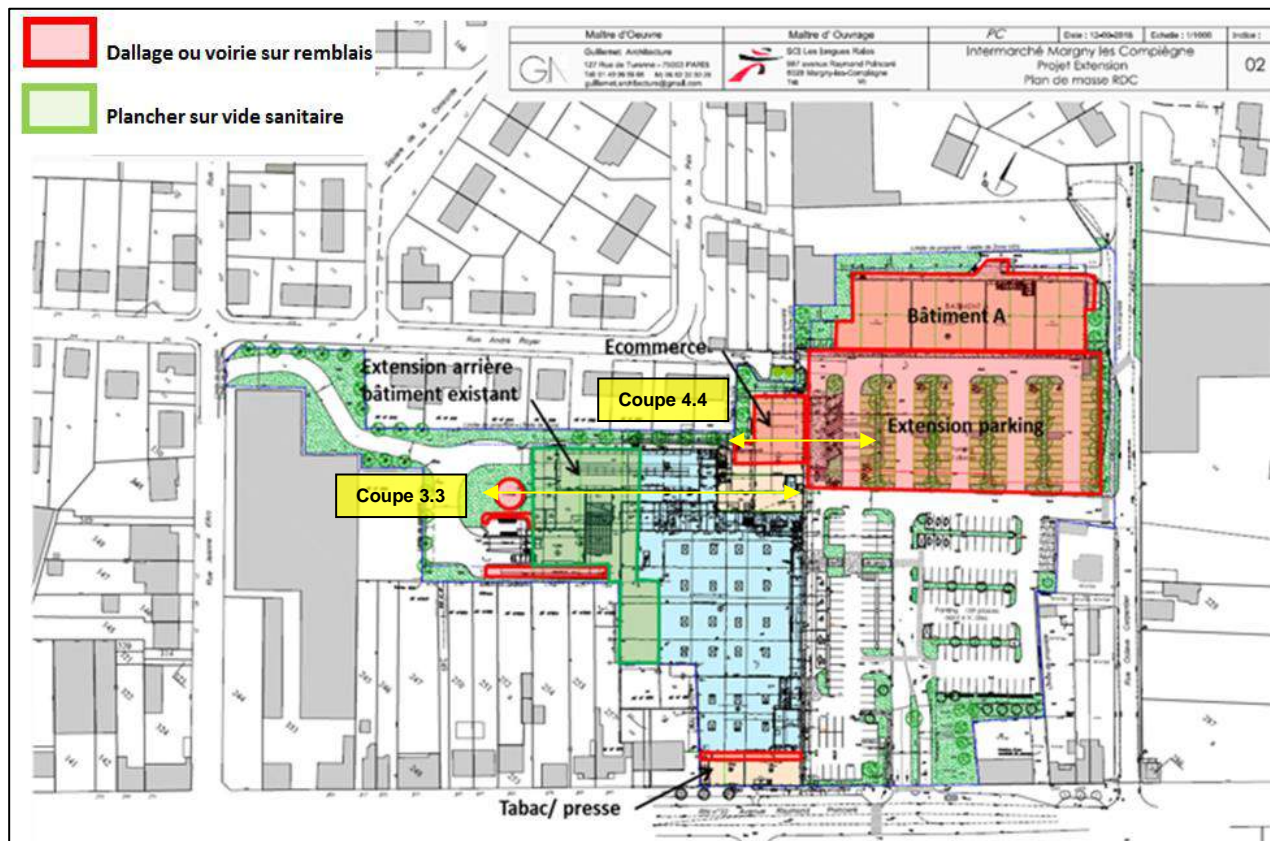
Localisation des emprises sur remblais ou sur vide sanitaire
